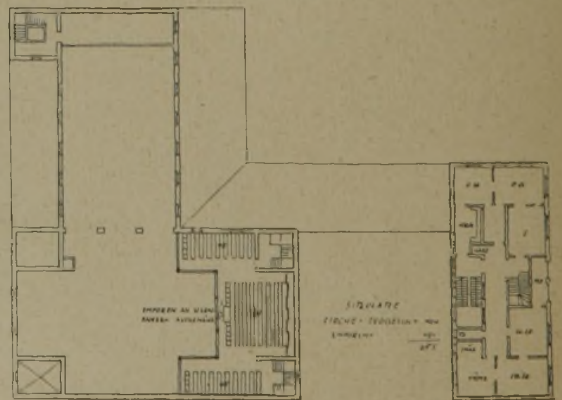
Grundriß vom Obergeschoß und Empore. (1 : 800.)
